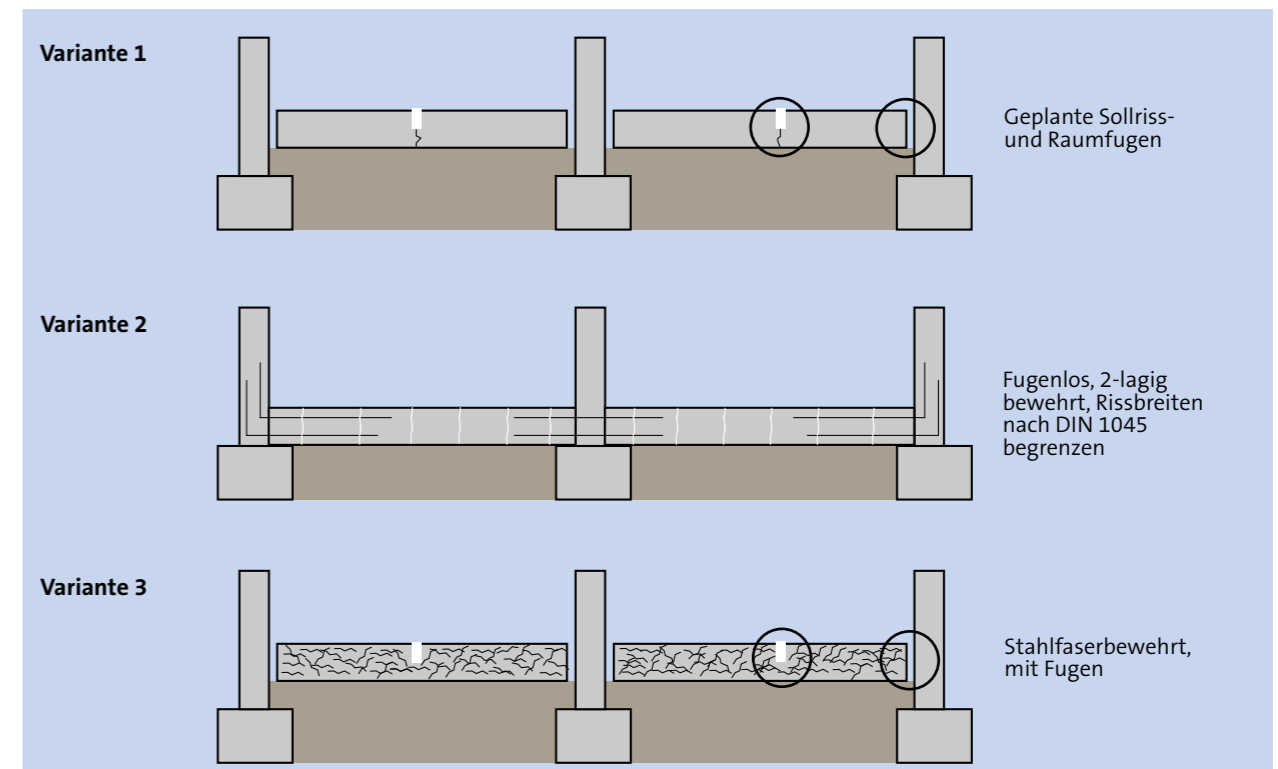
Konstruktion beeinflusst Fugenplanung
